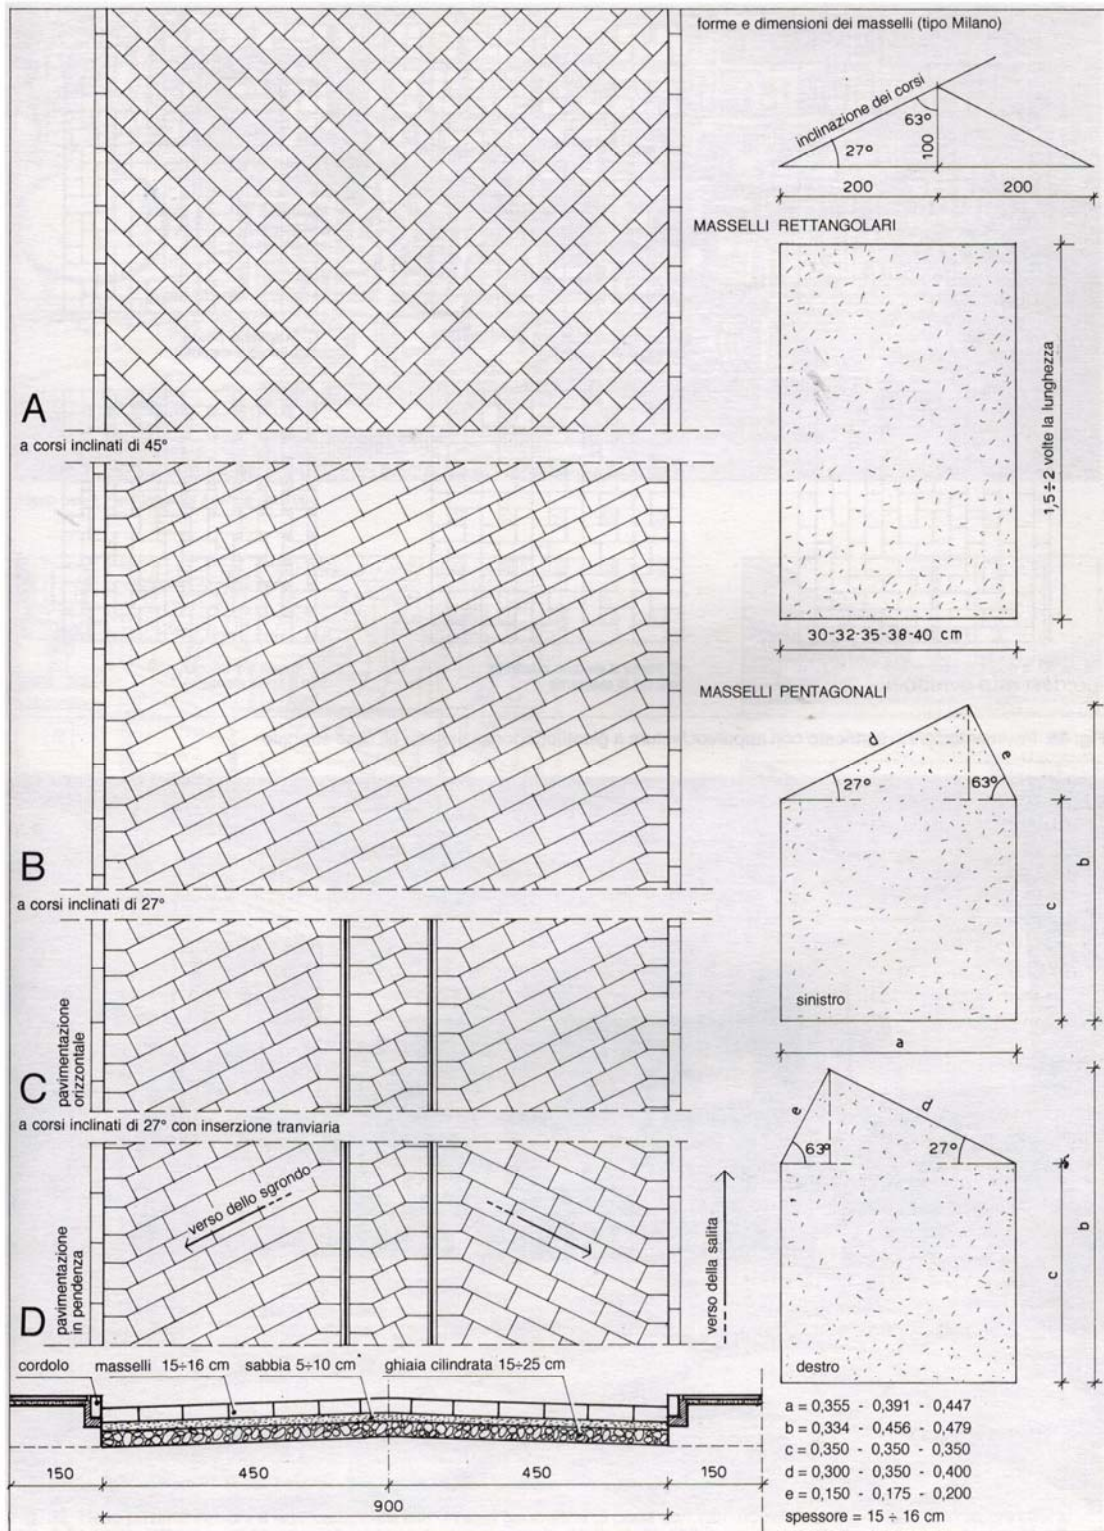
Lastricati con apparecchiature a corsi inclinati rispetto all'asse della via.
